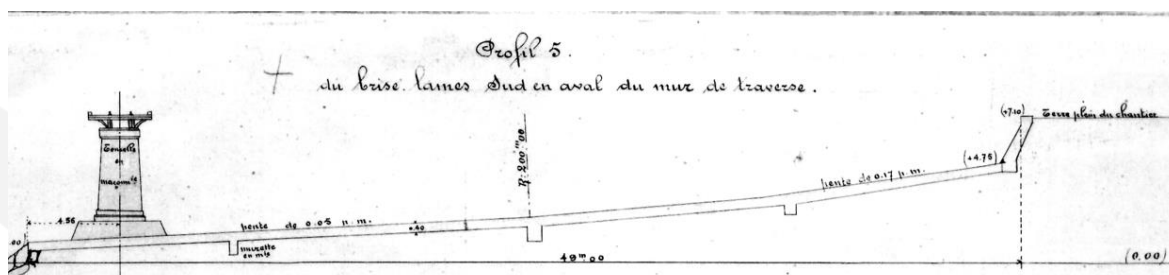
Profil type au droit de la plage d'épanouissement présente à l'amont de l'ouvrage le long du mur de raccordement
